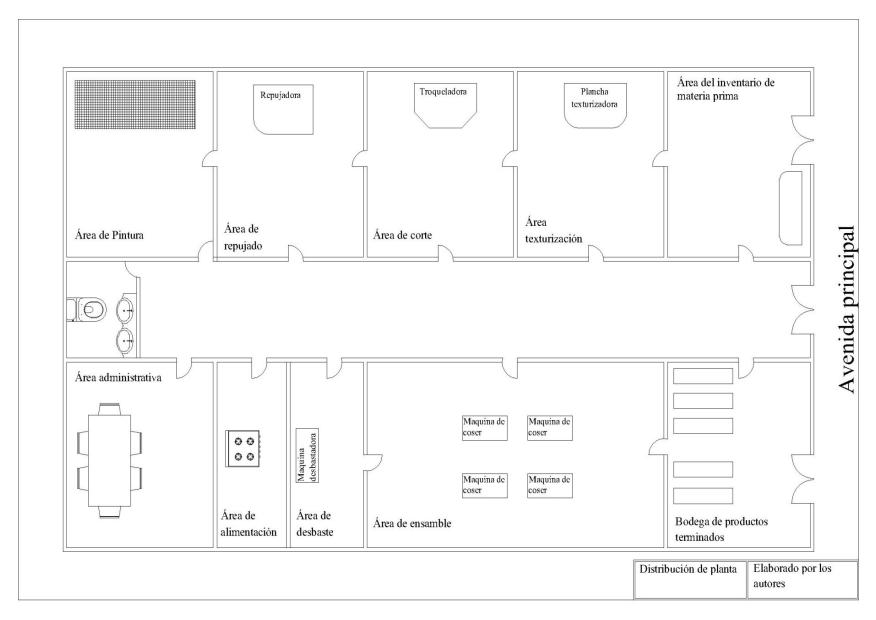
Distribución de planta de la empresa Arte & Cuero. Fuente: Elaborado por los autores
